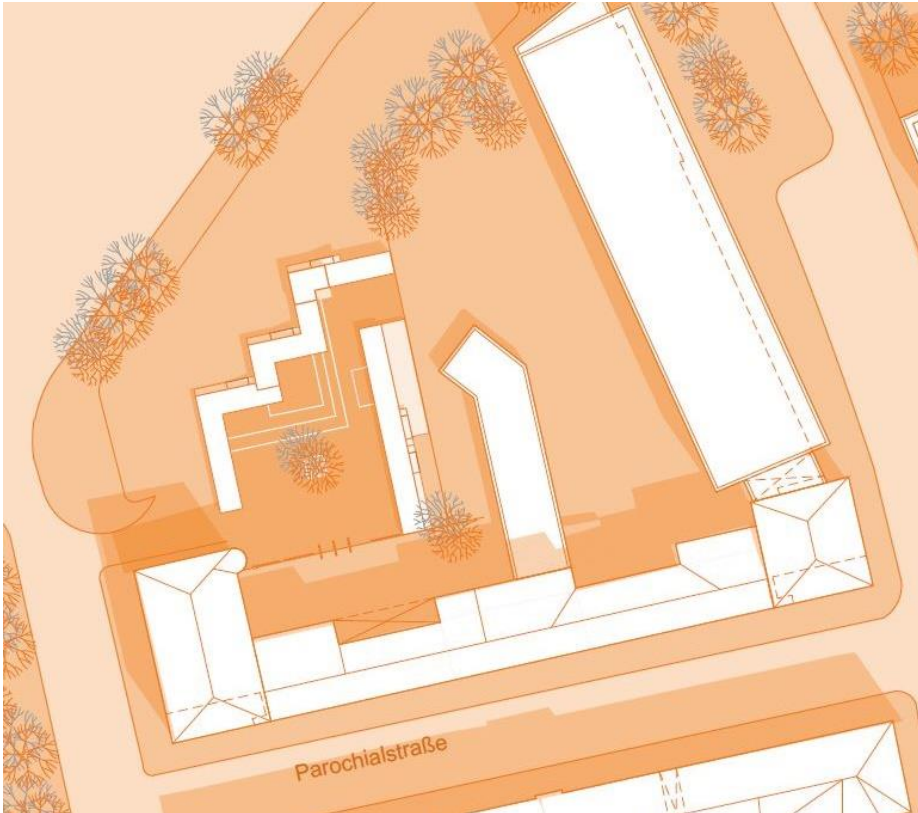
Entwurf J-house, Lageplan, KARO Architekten
